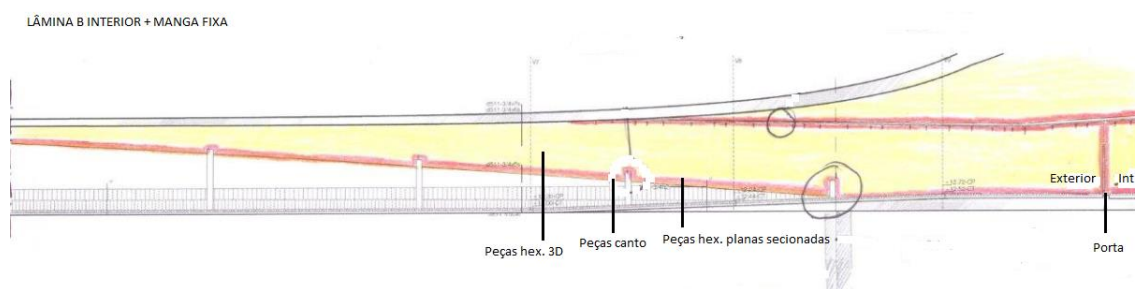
Alçado planificado rebatido do lado interior da lâmina B que faz o teto da Manga Fixa e na qual é visível a separação com o espaço considerado zona interior.
